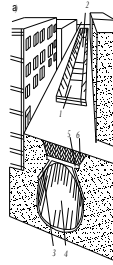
Схема спорудження тунелю з плоским перекриттям:
